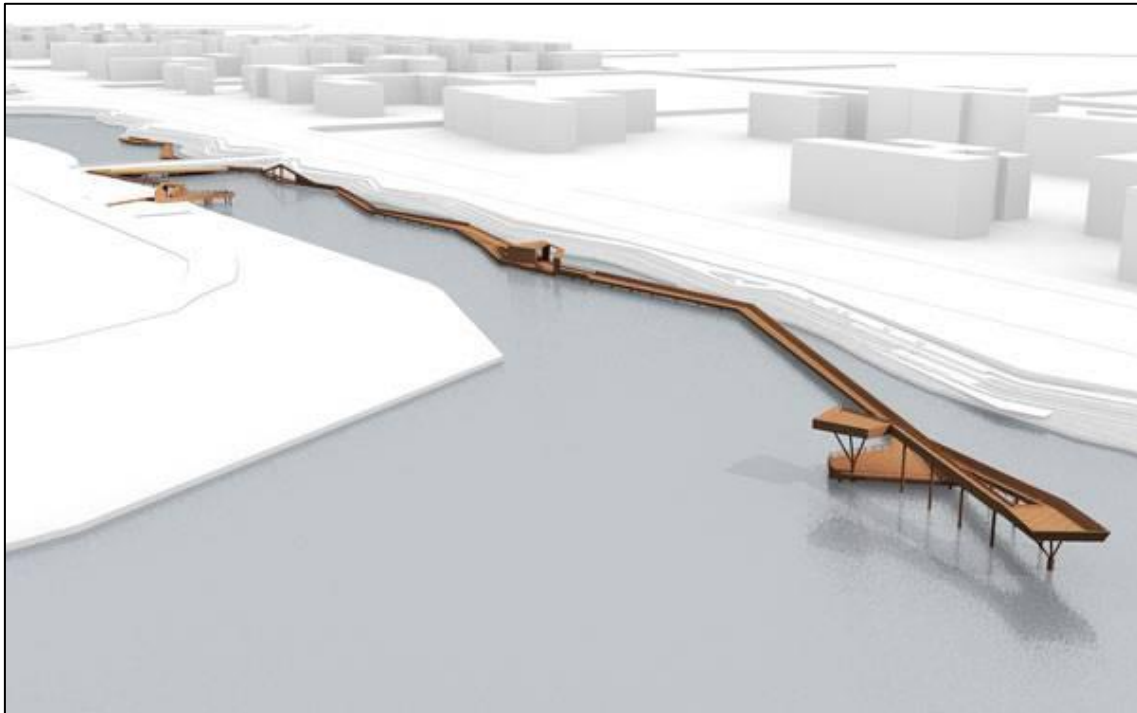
Planta de proyecto Parque costero en el Río Aiyi.
